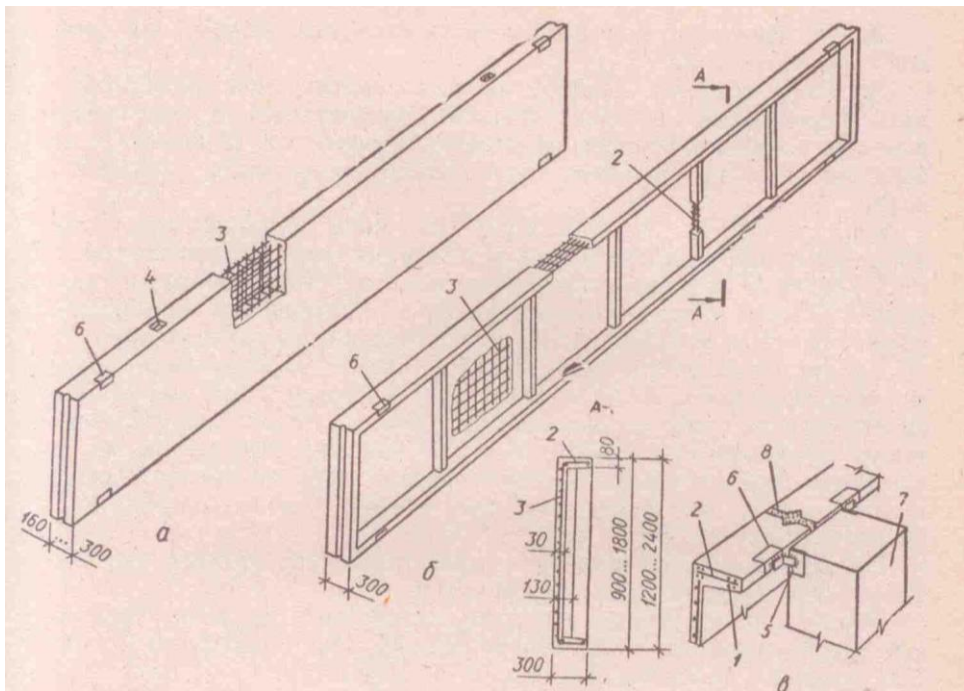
Стінові панелі: а – суцільна з легких блоків для опалювальних будівель; б – залізобетонна одношарова для неопалювальних будівель; в – вузол кріплення панелей до колони; 1 – напружувана арматура Вр-II; 2 – зварний каркас; 3 – зварна сітка; 4 – гніздо з петлею; 5 – сполучна планка на зварюванні; 6 – закладна деталь; 7 – колона; 8 – замонолічування піщаним бетоном
